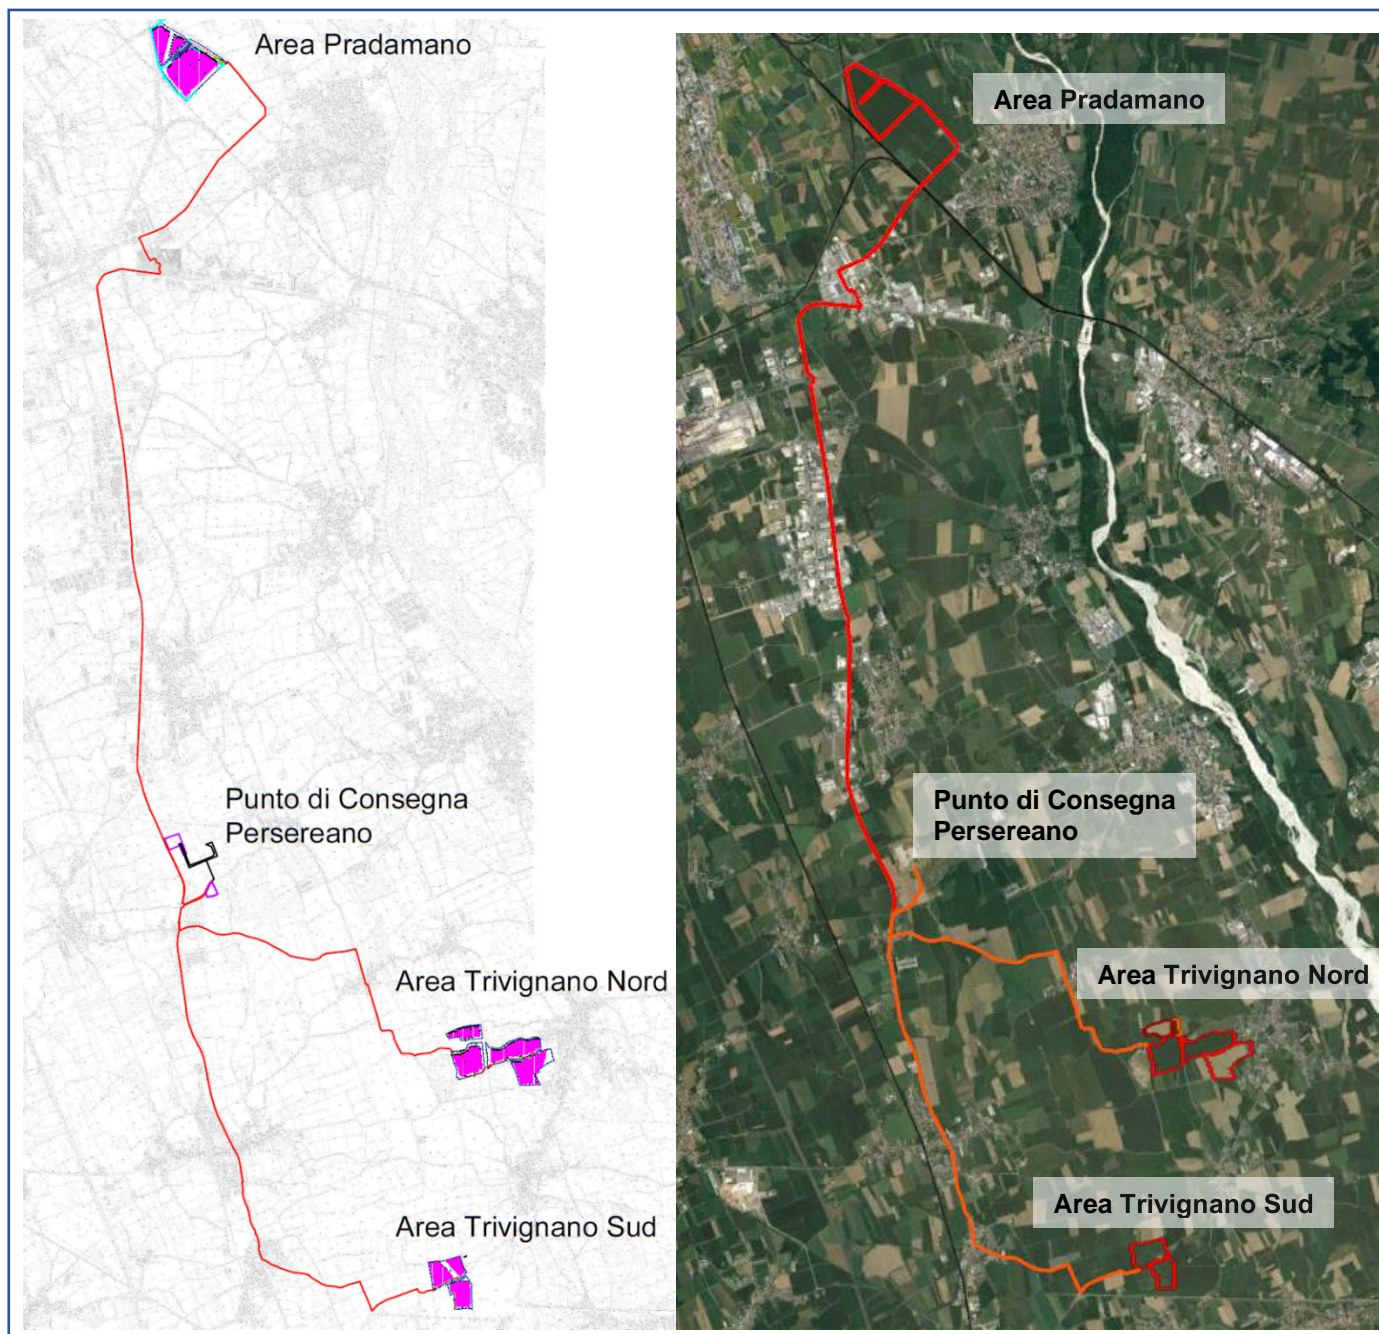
Planimetria e collegamenti su CTRN e su ortofoto dell'opera completa
